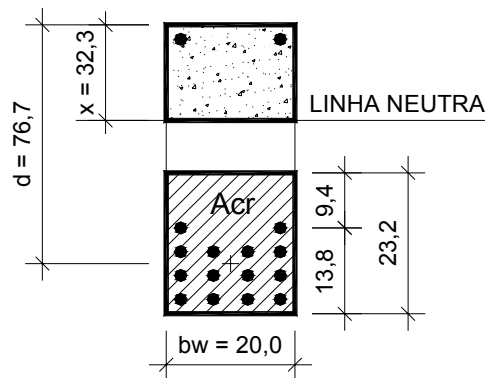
ELS-W – Determinação da área do concreto de envolvimento na seção de concreto armado
